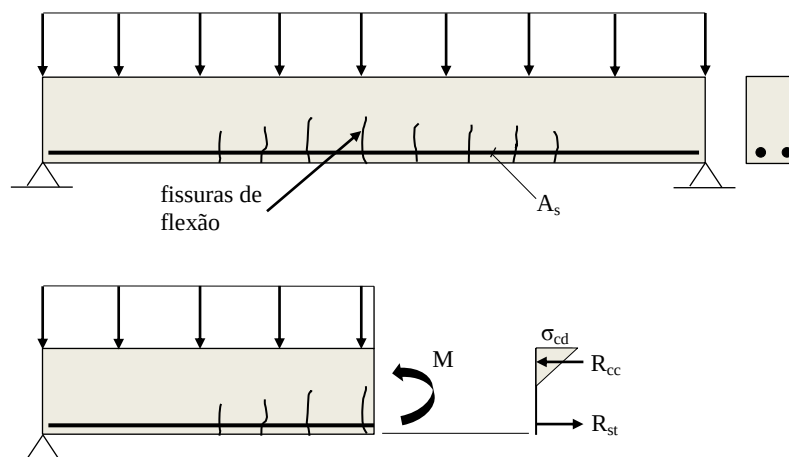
Viga de Concreto Armado fissurada, com diagrama linear de tensões normais de compressão e forças normais resultantes.^[1]
